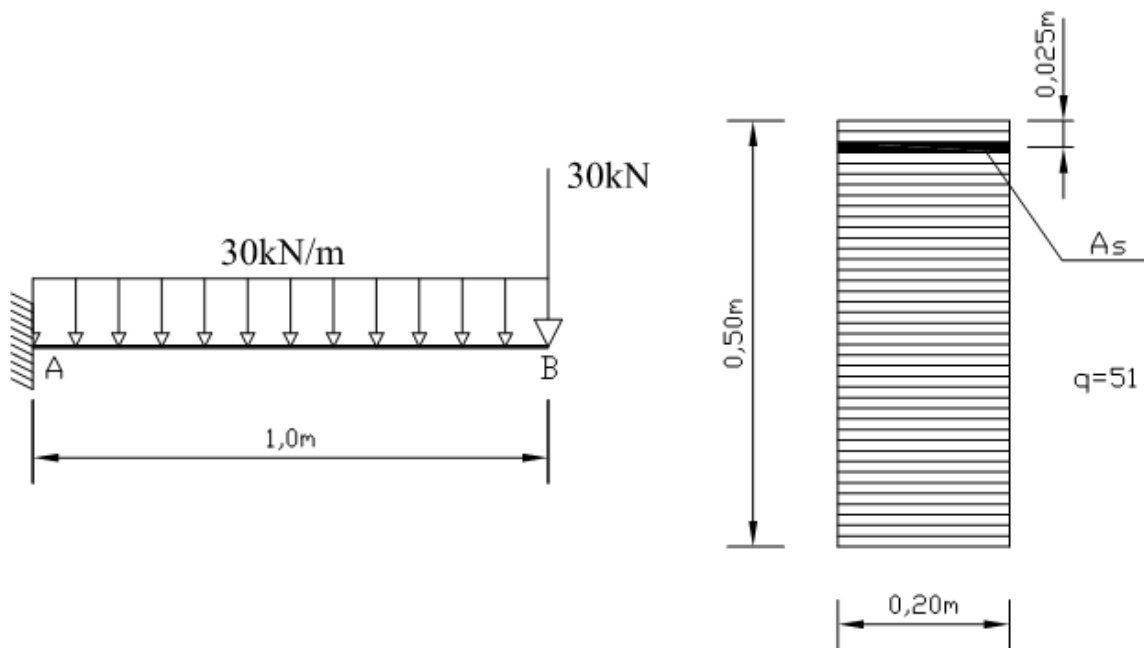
Viga em balanço de concreto armado (Fonseca, 2006).
